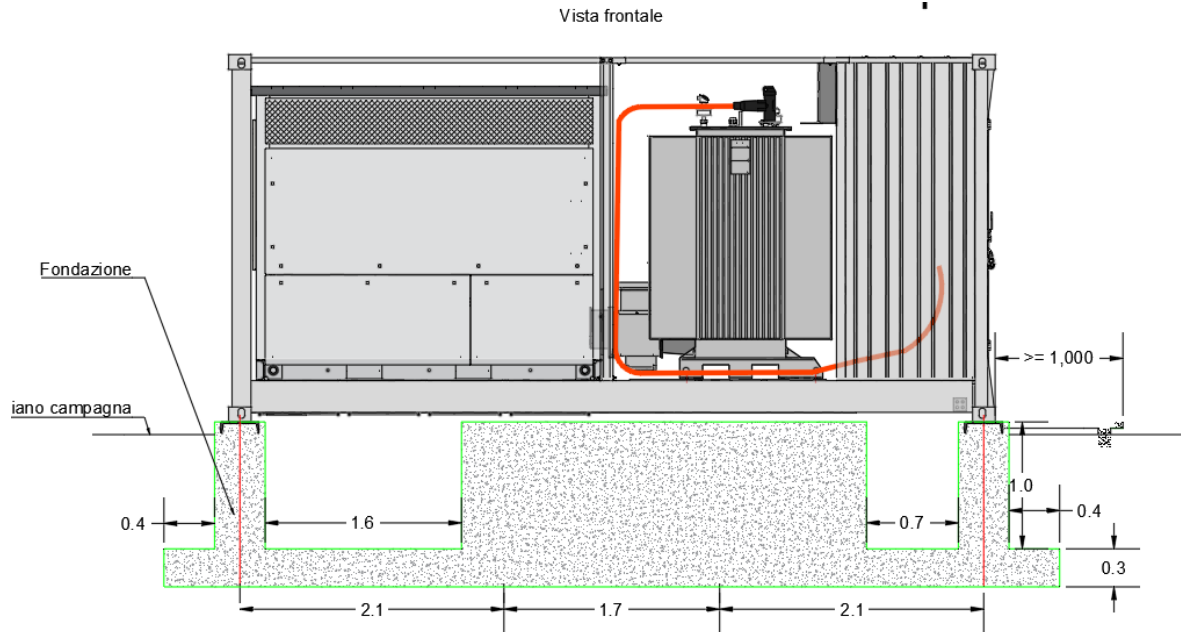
Vista frontale PS di progetto con fondazione in calcestruzzo armato
